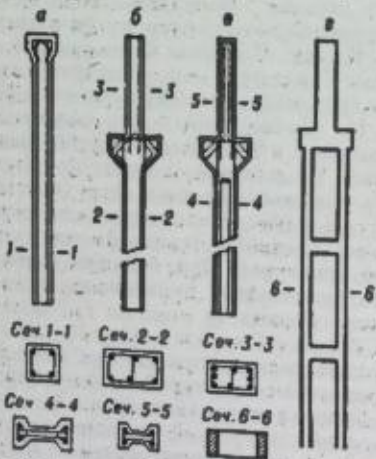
Колонны одноэтажных промышленных зданий: а — бесспиральные прямоугольного сечения; б — спиральные прямоугольного сечения; в — спиральные двутаврового сечения; г — двухветвенные.
